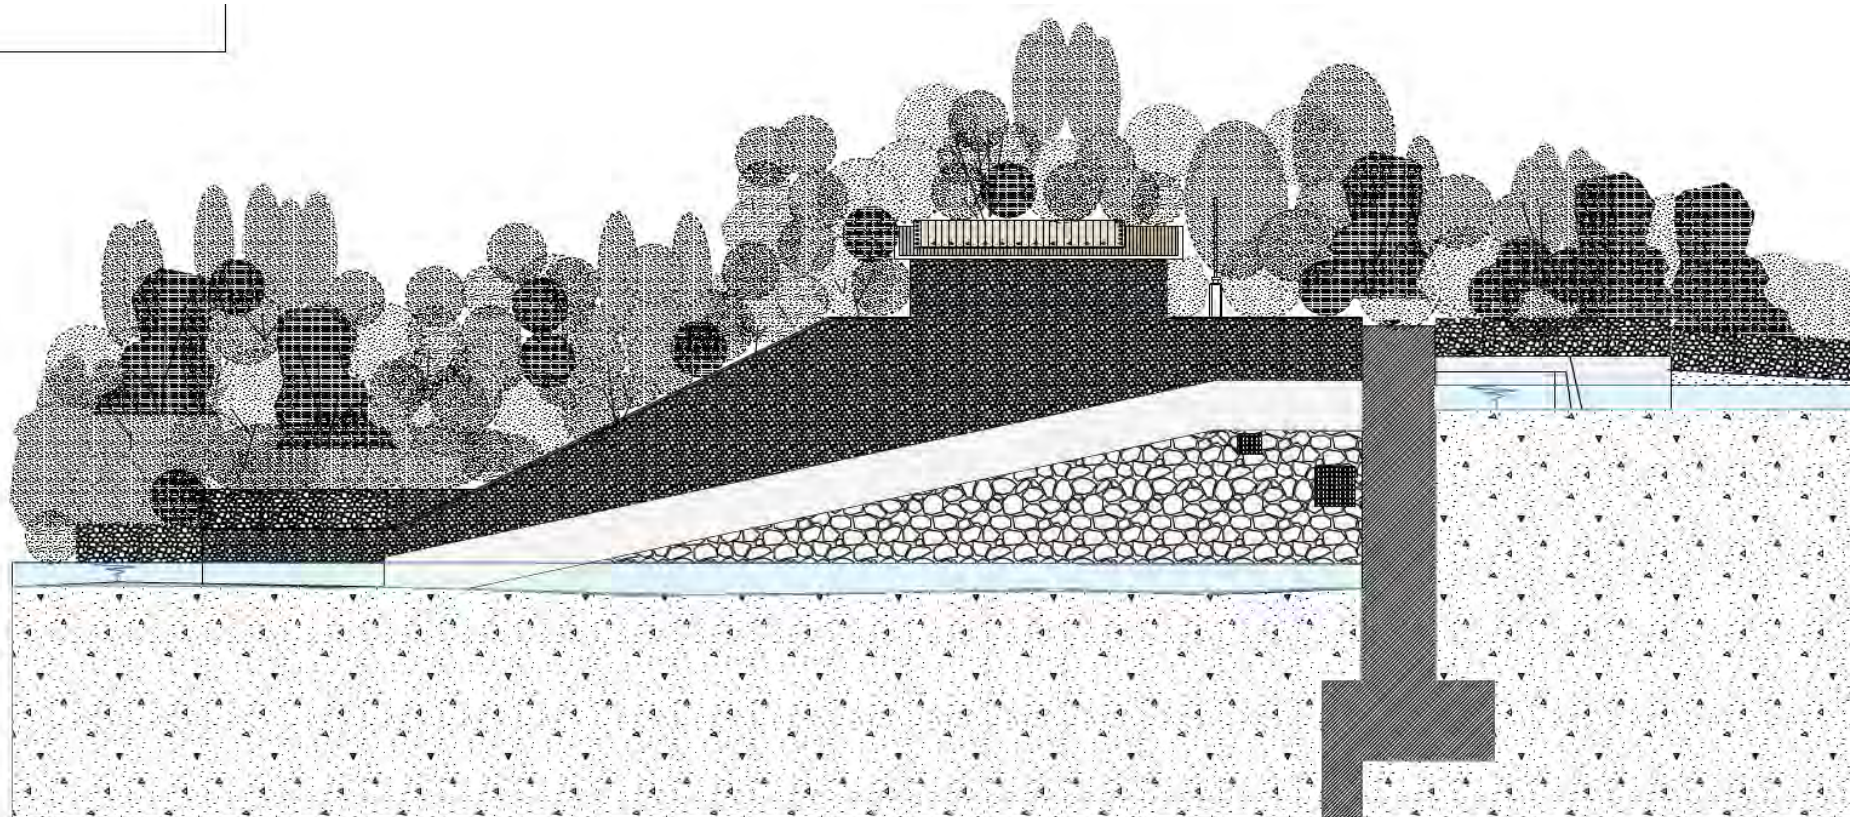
Prospetto ovest del progetto dopo il ripristino post-cantiere
